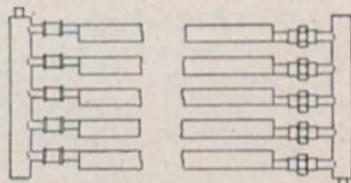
Liegendes Rohrregister mit geschweißten Sammelstücken.
